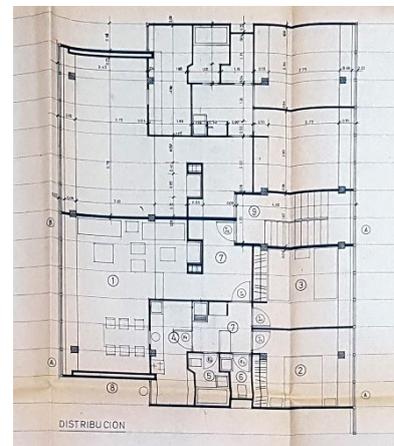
Plantas Distribución B-2-2. 1964. Fuente: Archivo Municipal da Coruña
